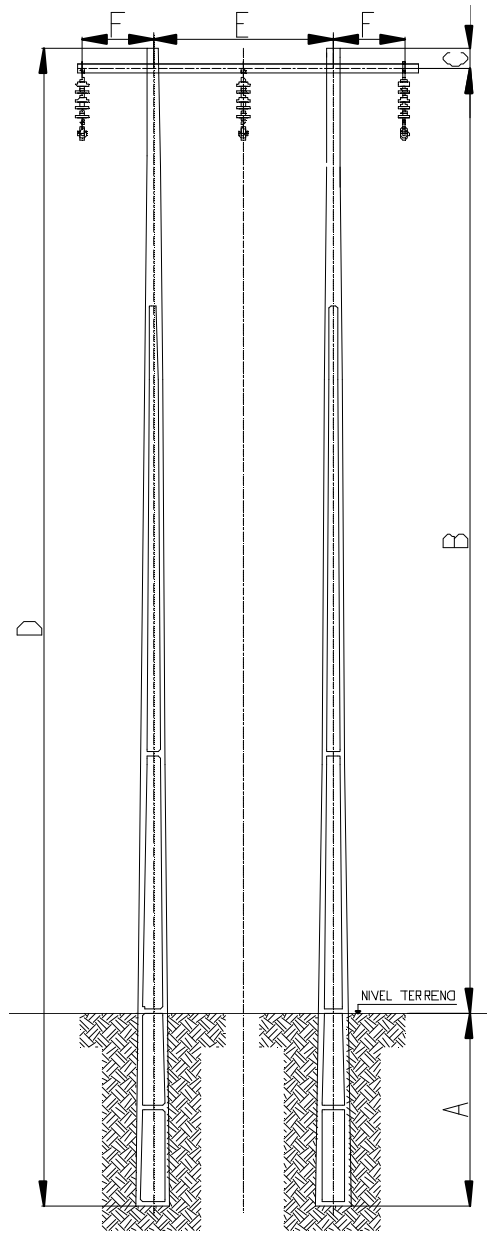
Geometría de estructura de anclaje tipo PQ 0-60.
